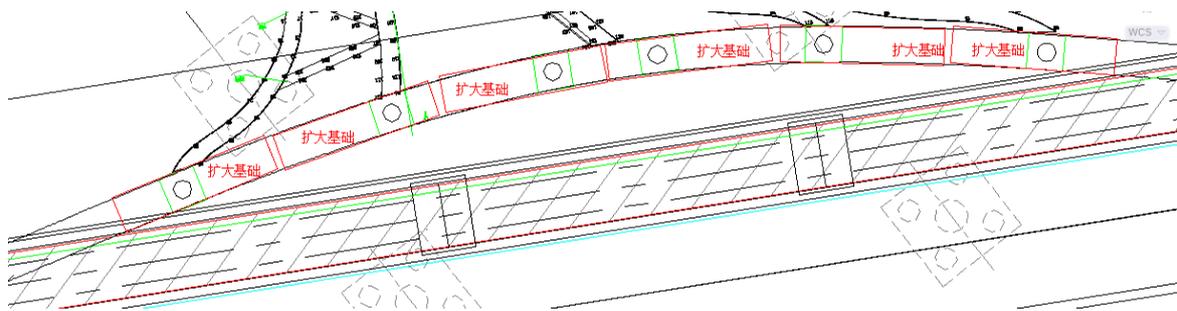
景观拱扩大临时支撑底座平面图(单位: mm)
